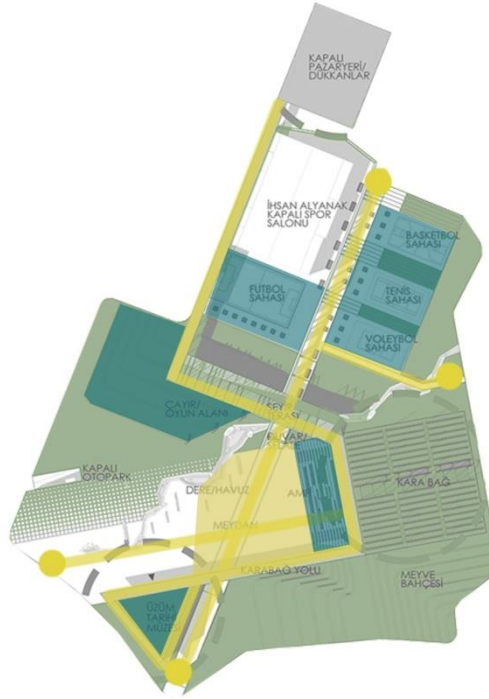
3. Ödül vaziyet planı (Karakoç, 2017)
